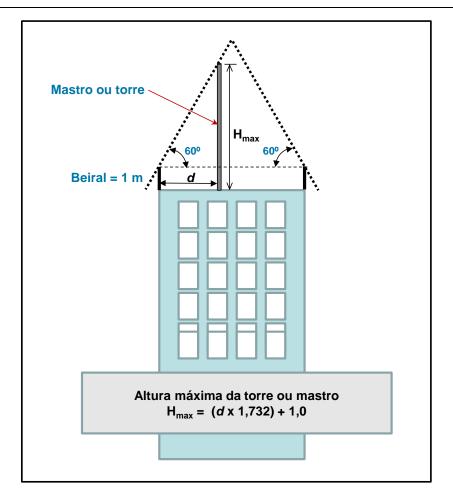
Cone de obstrução para instalações em infraestruturas de suporte do tipo rooftop
